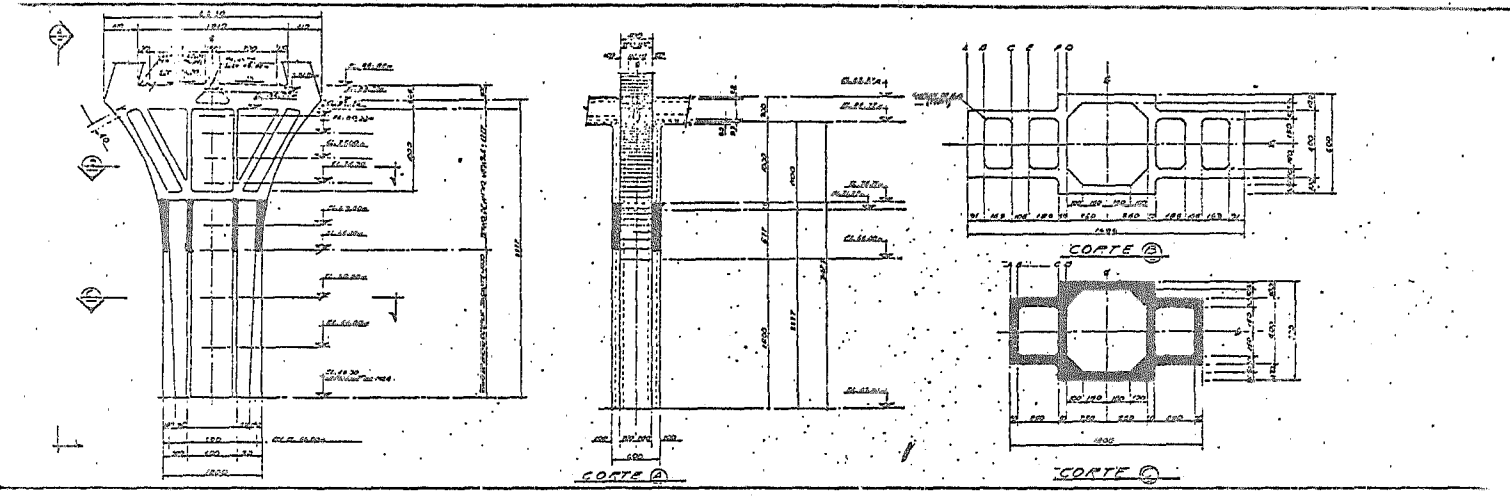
COLADO DEL NIVEL 66 AL 71.77. PILAS 4 Y 5
